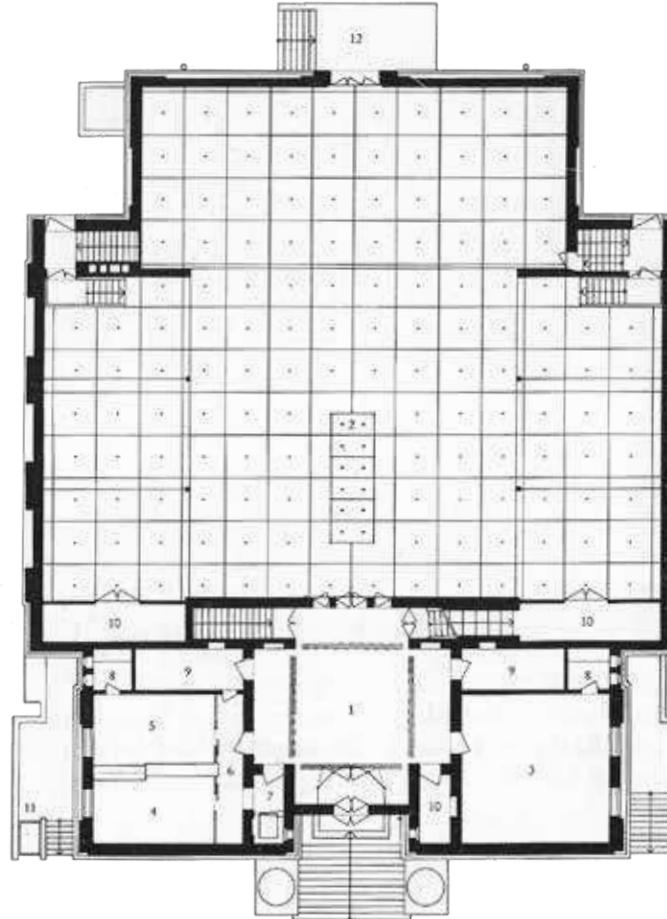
Grundriss Erdgeschoss, Maßstab ca.1:350, 1986
